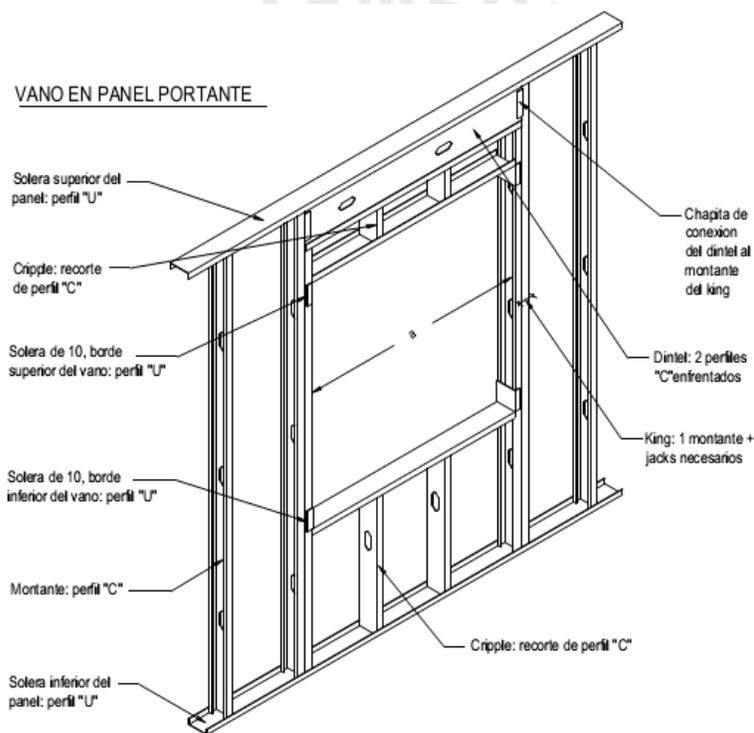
Detalle de vano en muro portante de Steel Framing. Fuente:ConsuSteel.
